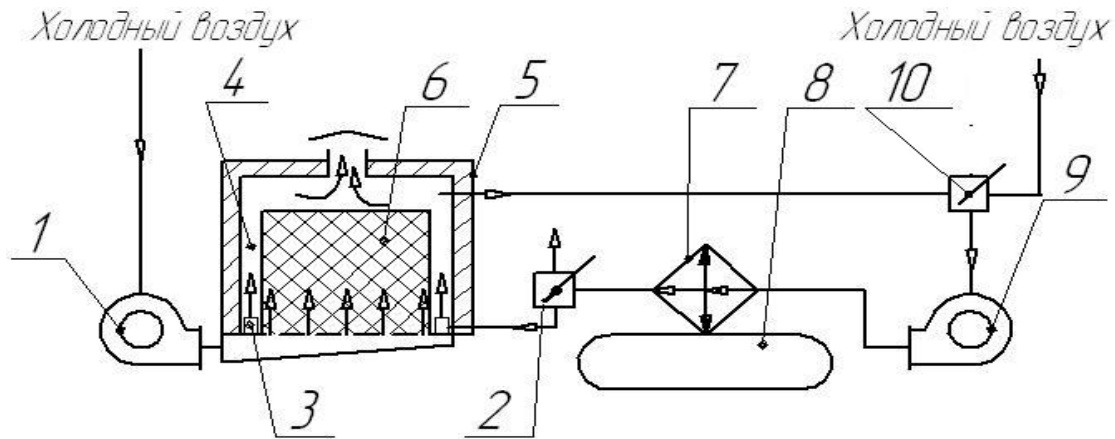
Схема плодовоовощехранилища с активным вентилированием и газогидратным хладоаккумулятором: 1, 9 – вентиляторы; 2, 10 – трехходовые клапаны; 3 – напольный воздуховод; 4 – воздушная прослойка; 5 – овощехранилище; 6 – продукт; 7 – воздухоохладитель; 8 – аккумулятор холода.
